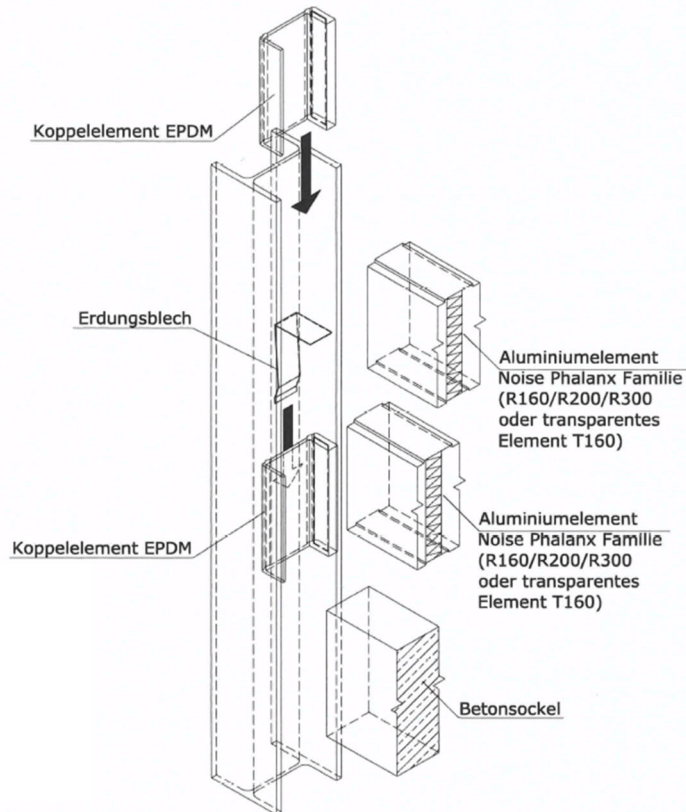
Details Erdungsblech Noise Phalanx Typ R160-EA(R) und Typ R160-BA(R)
